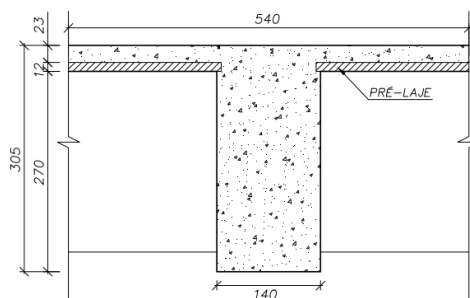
Seção transversal para o dimensionamento (dimensões em centímetros).
